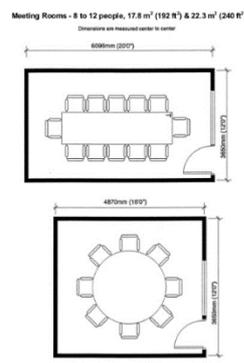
Dokumentasi Planner Room, Coworking space A+
